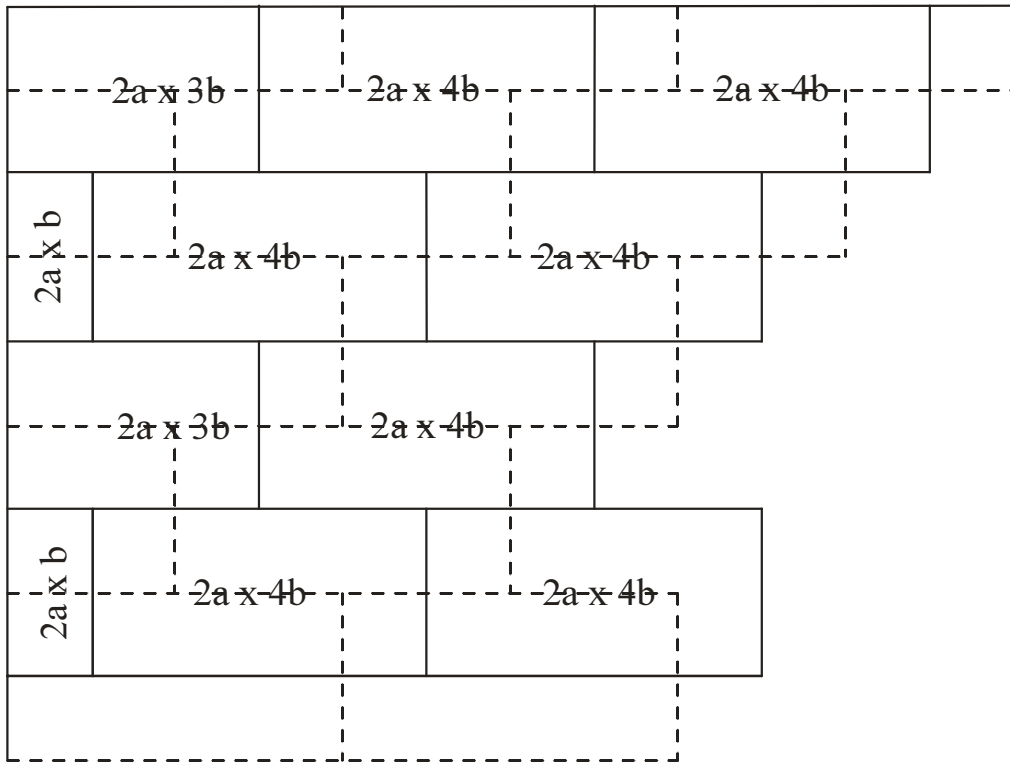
Раскладка теплоизоляционных плит при двухслойной укладке
